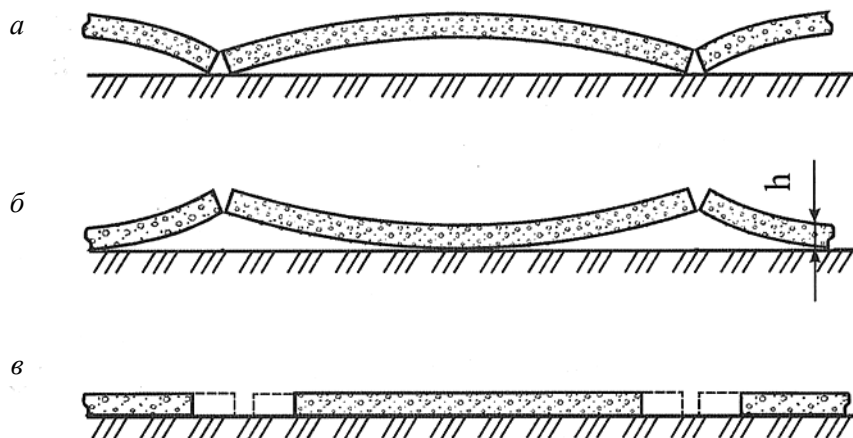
Температурные деформации плит бетонных покрытий:
